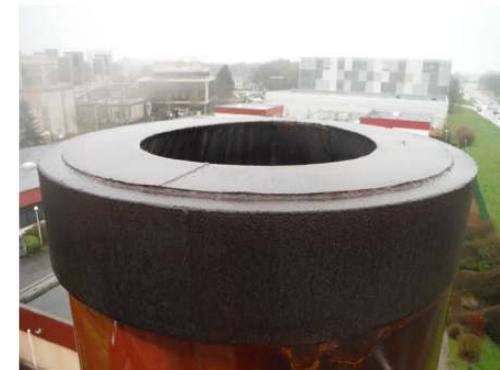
Bandeau et retour d'étanchéité au sommet – oxydation en surface
